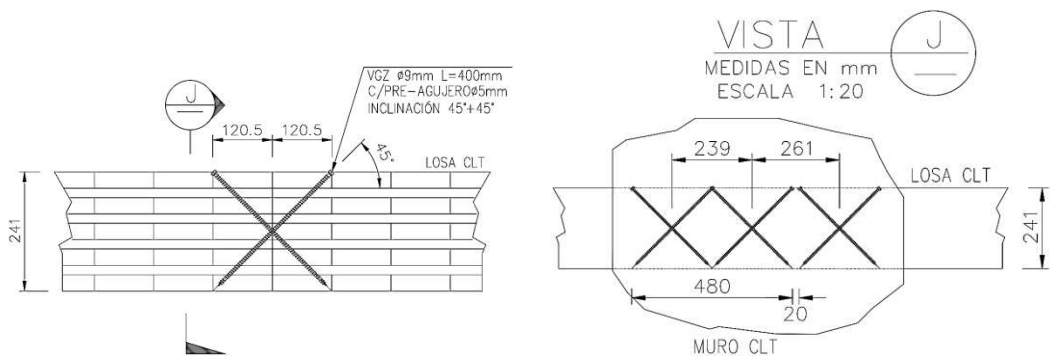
Detalle conexión losa-losa, vista en elevación y planta (mm)
